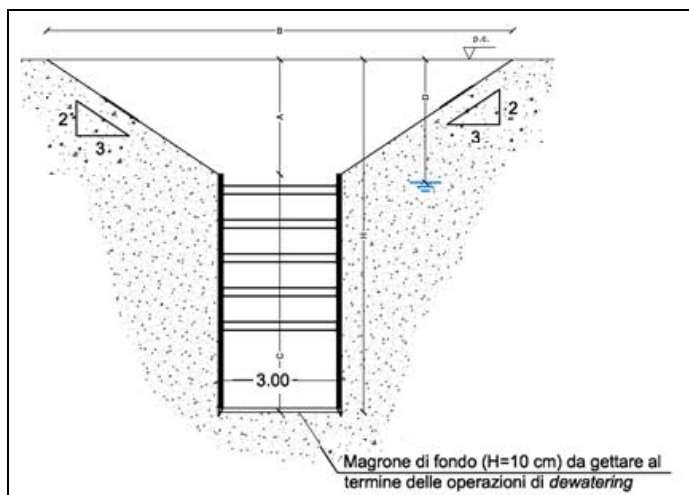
r – Sezione del dreno in un tratto non coincidente con il nuovo T. Marmazza - scavo armato
